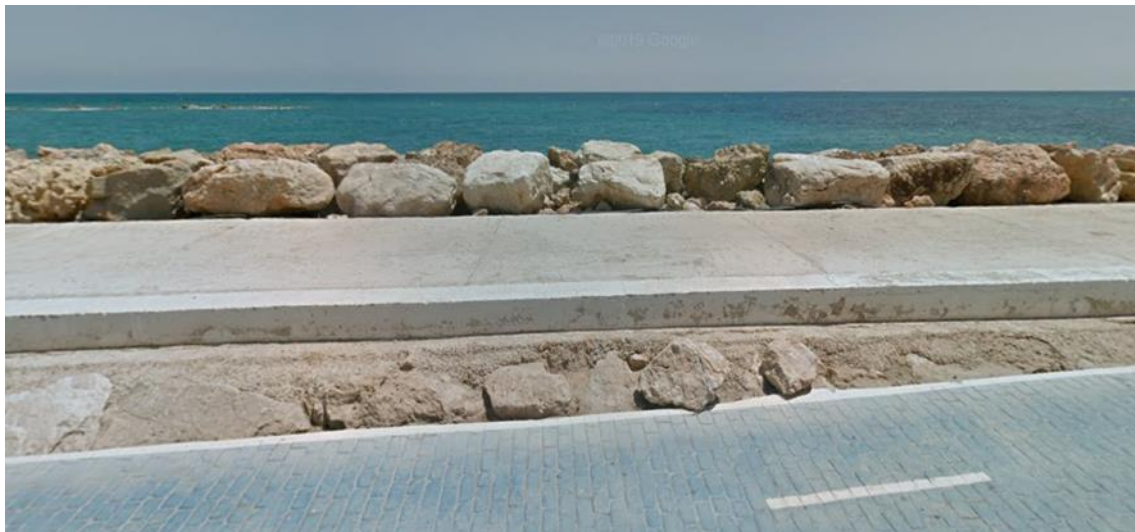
Sección trapezoidal de la protección longitudinal a desmantelar. Fuente: Propia
